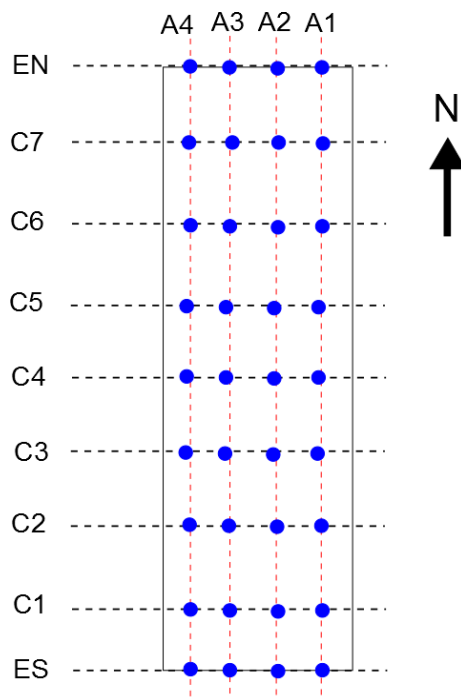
Vista en planta - Numeración de los aisladores por apoyo.
